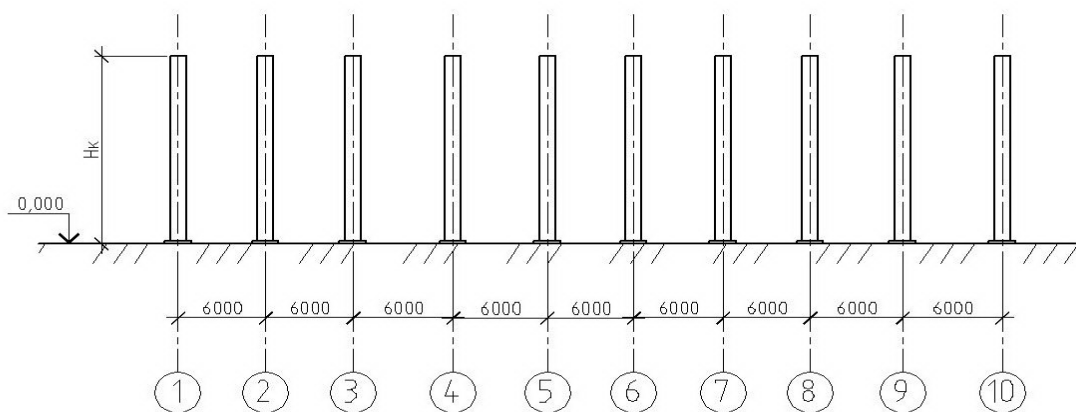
Клетка колонн 6x12, План, Разрез 1-1
